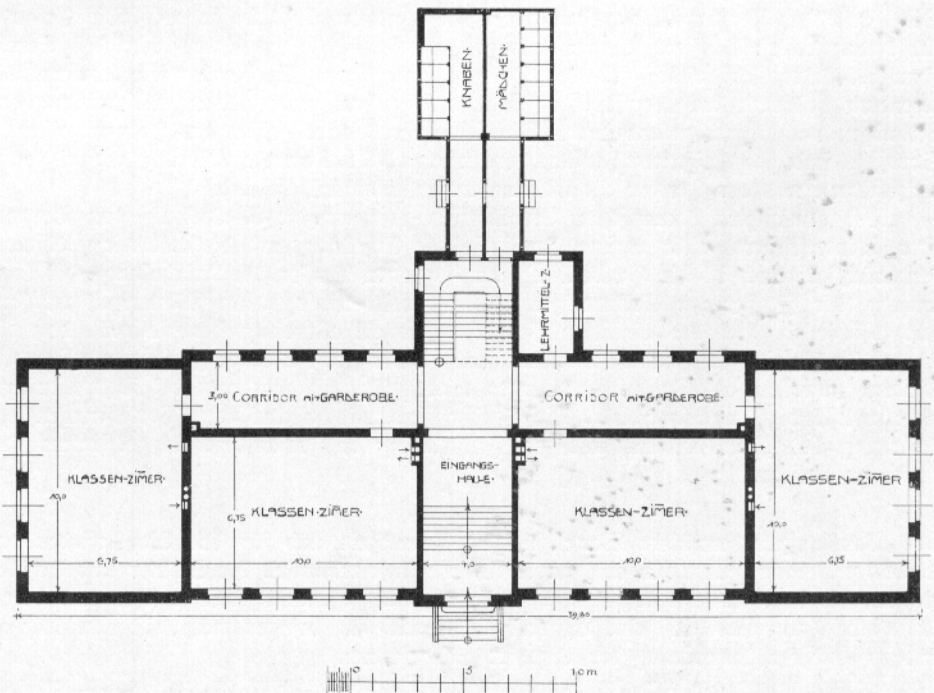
Grundriß einer vierklassigen Landschule mit Lehrerwohnungen.
